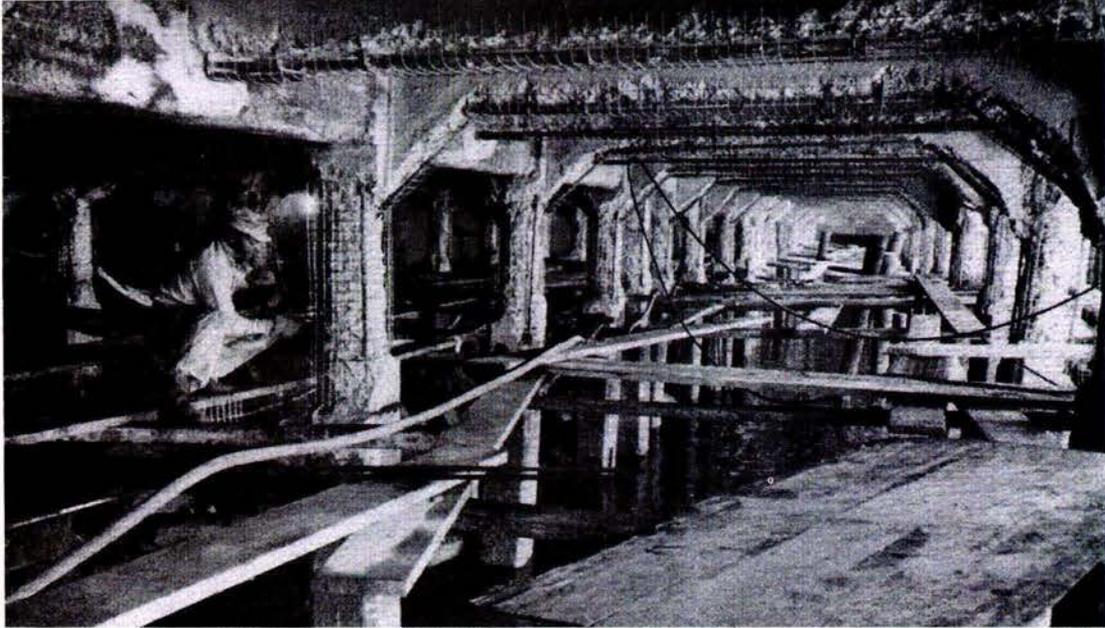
Estructura dañada en el acero de refuerzo por agua salada
